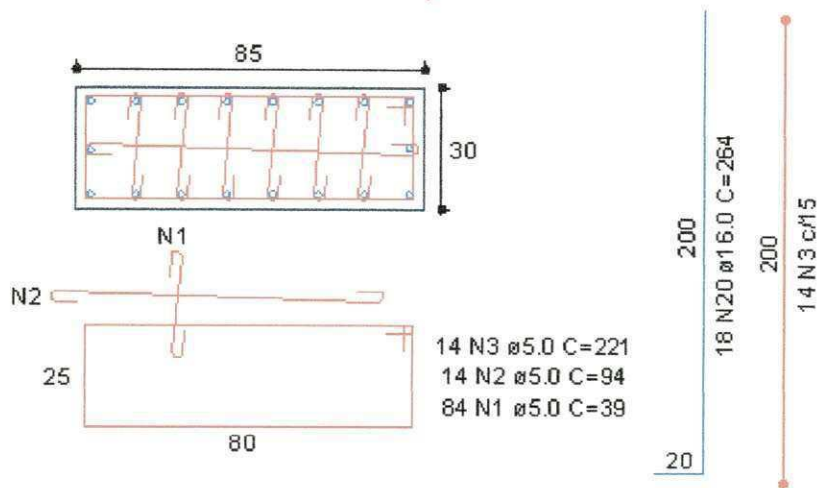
Detalhe do arranque do pilar P11-12.
